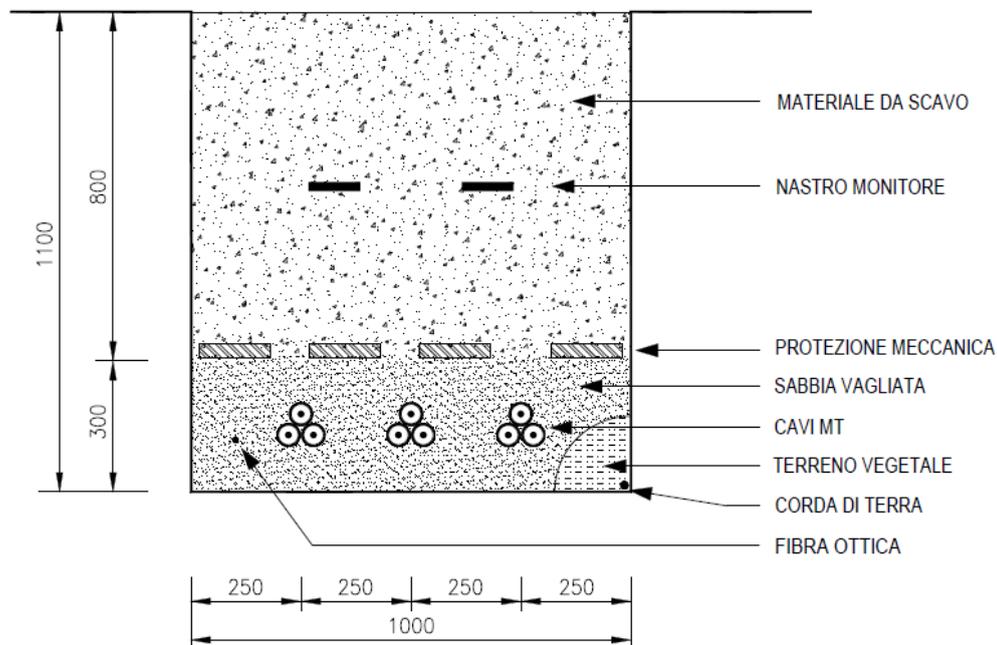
Sezione tipica di posa della linea in cavo su strade sterrate
